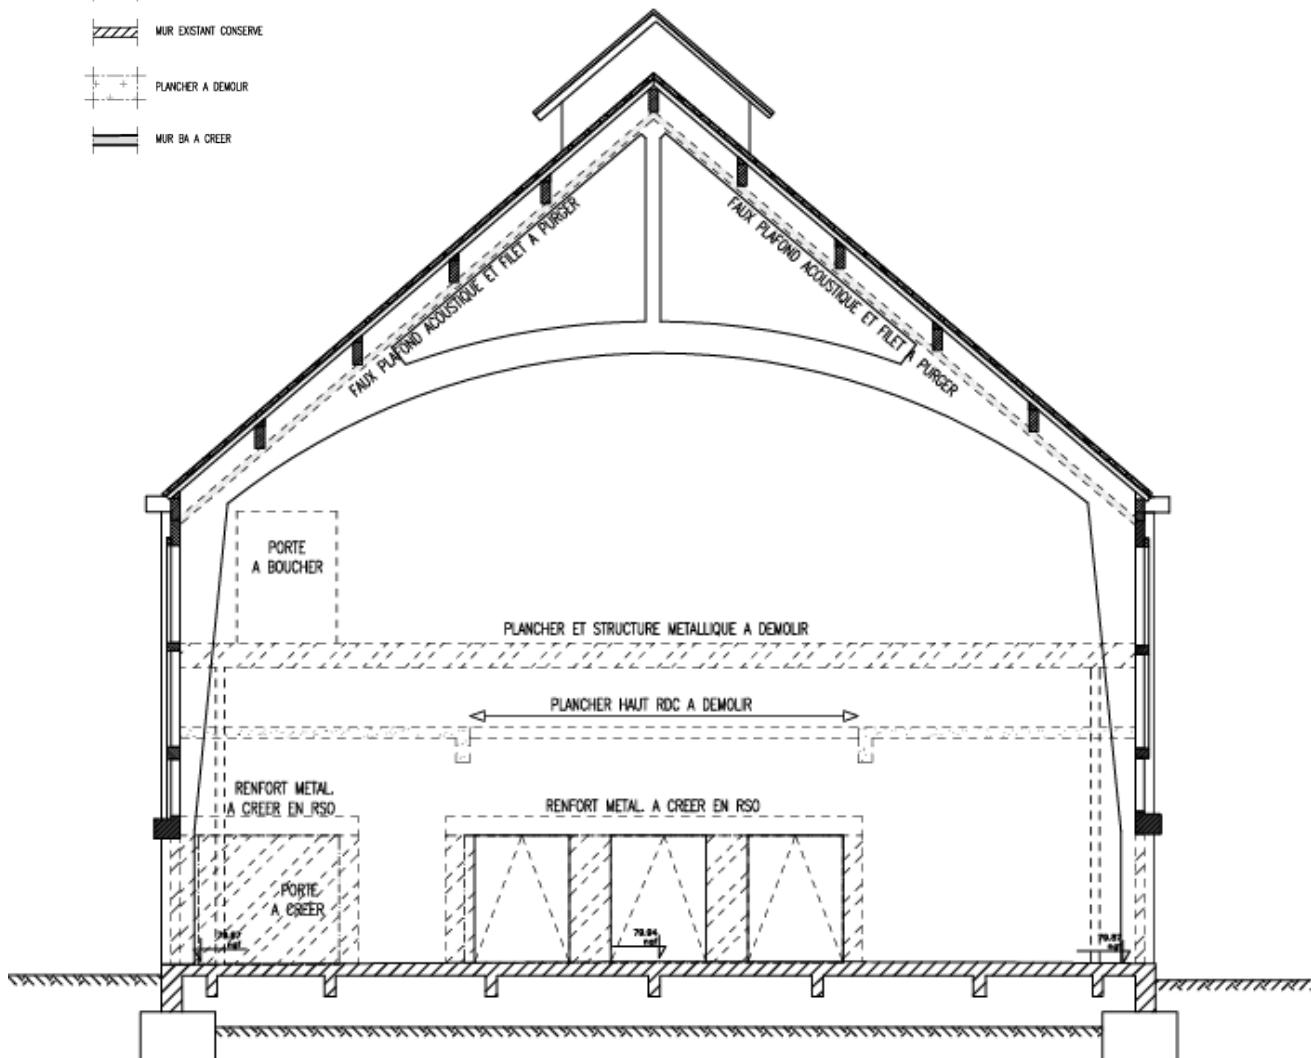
coupe de la chapelle indiquant la destruction du plancher haut \_ Phillippe Gibert Architecte
